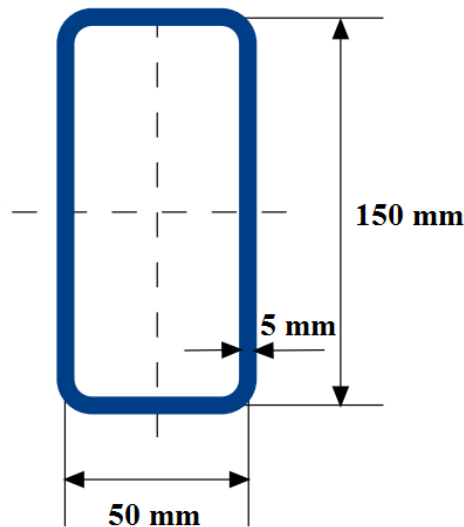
Dimensiones de la tubería rectangular (Anexo G)
